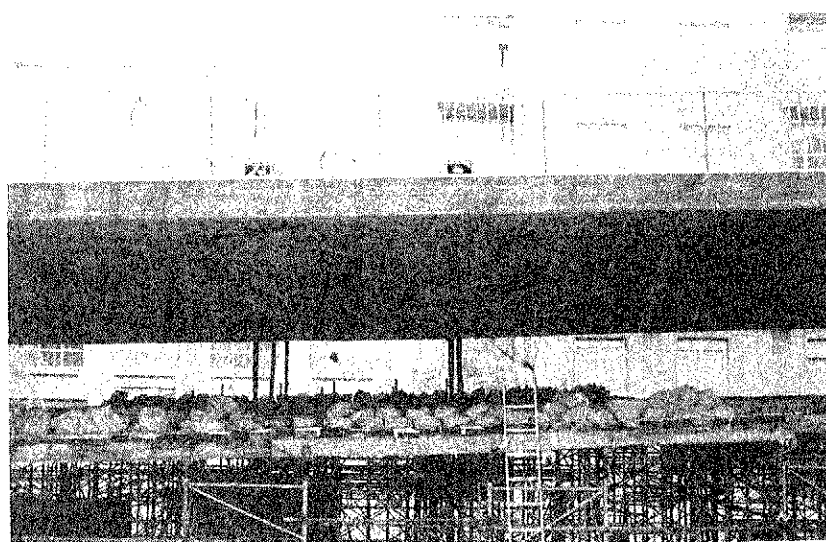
Fisuración alcanzada durante la prueba. Vista general.
